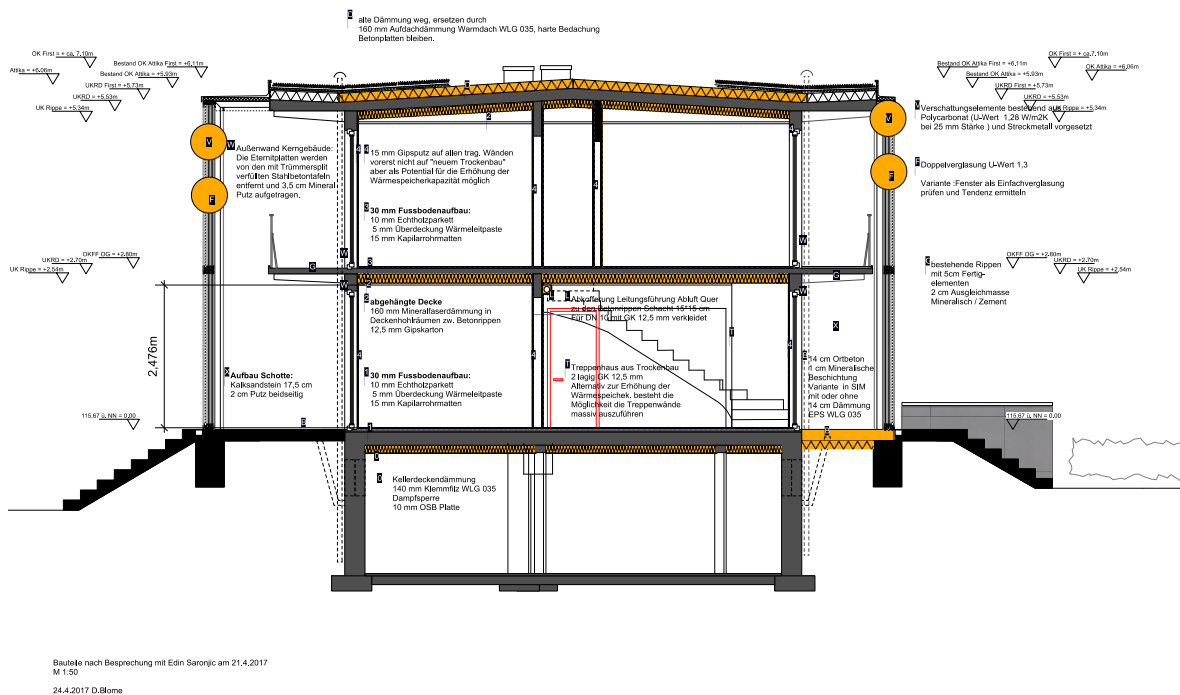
Gebäudeschnitt mit Darstellung der Bauteilaufbauten. Quelle: Email
